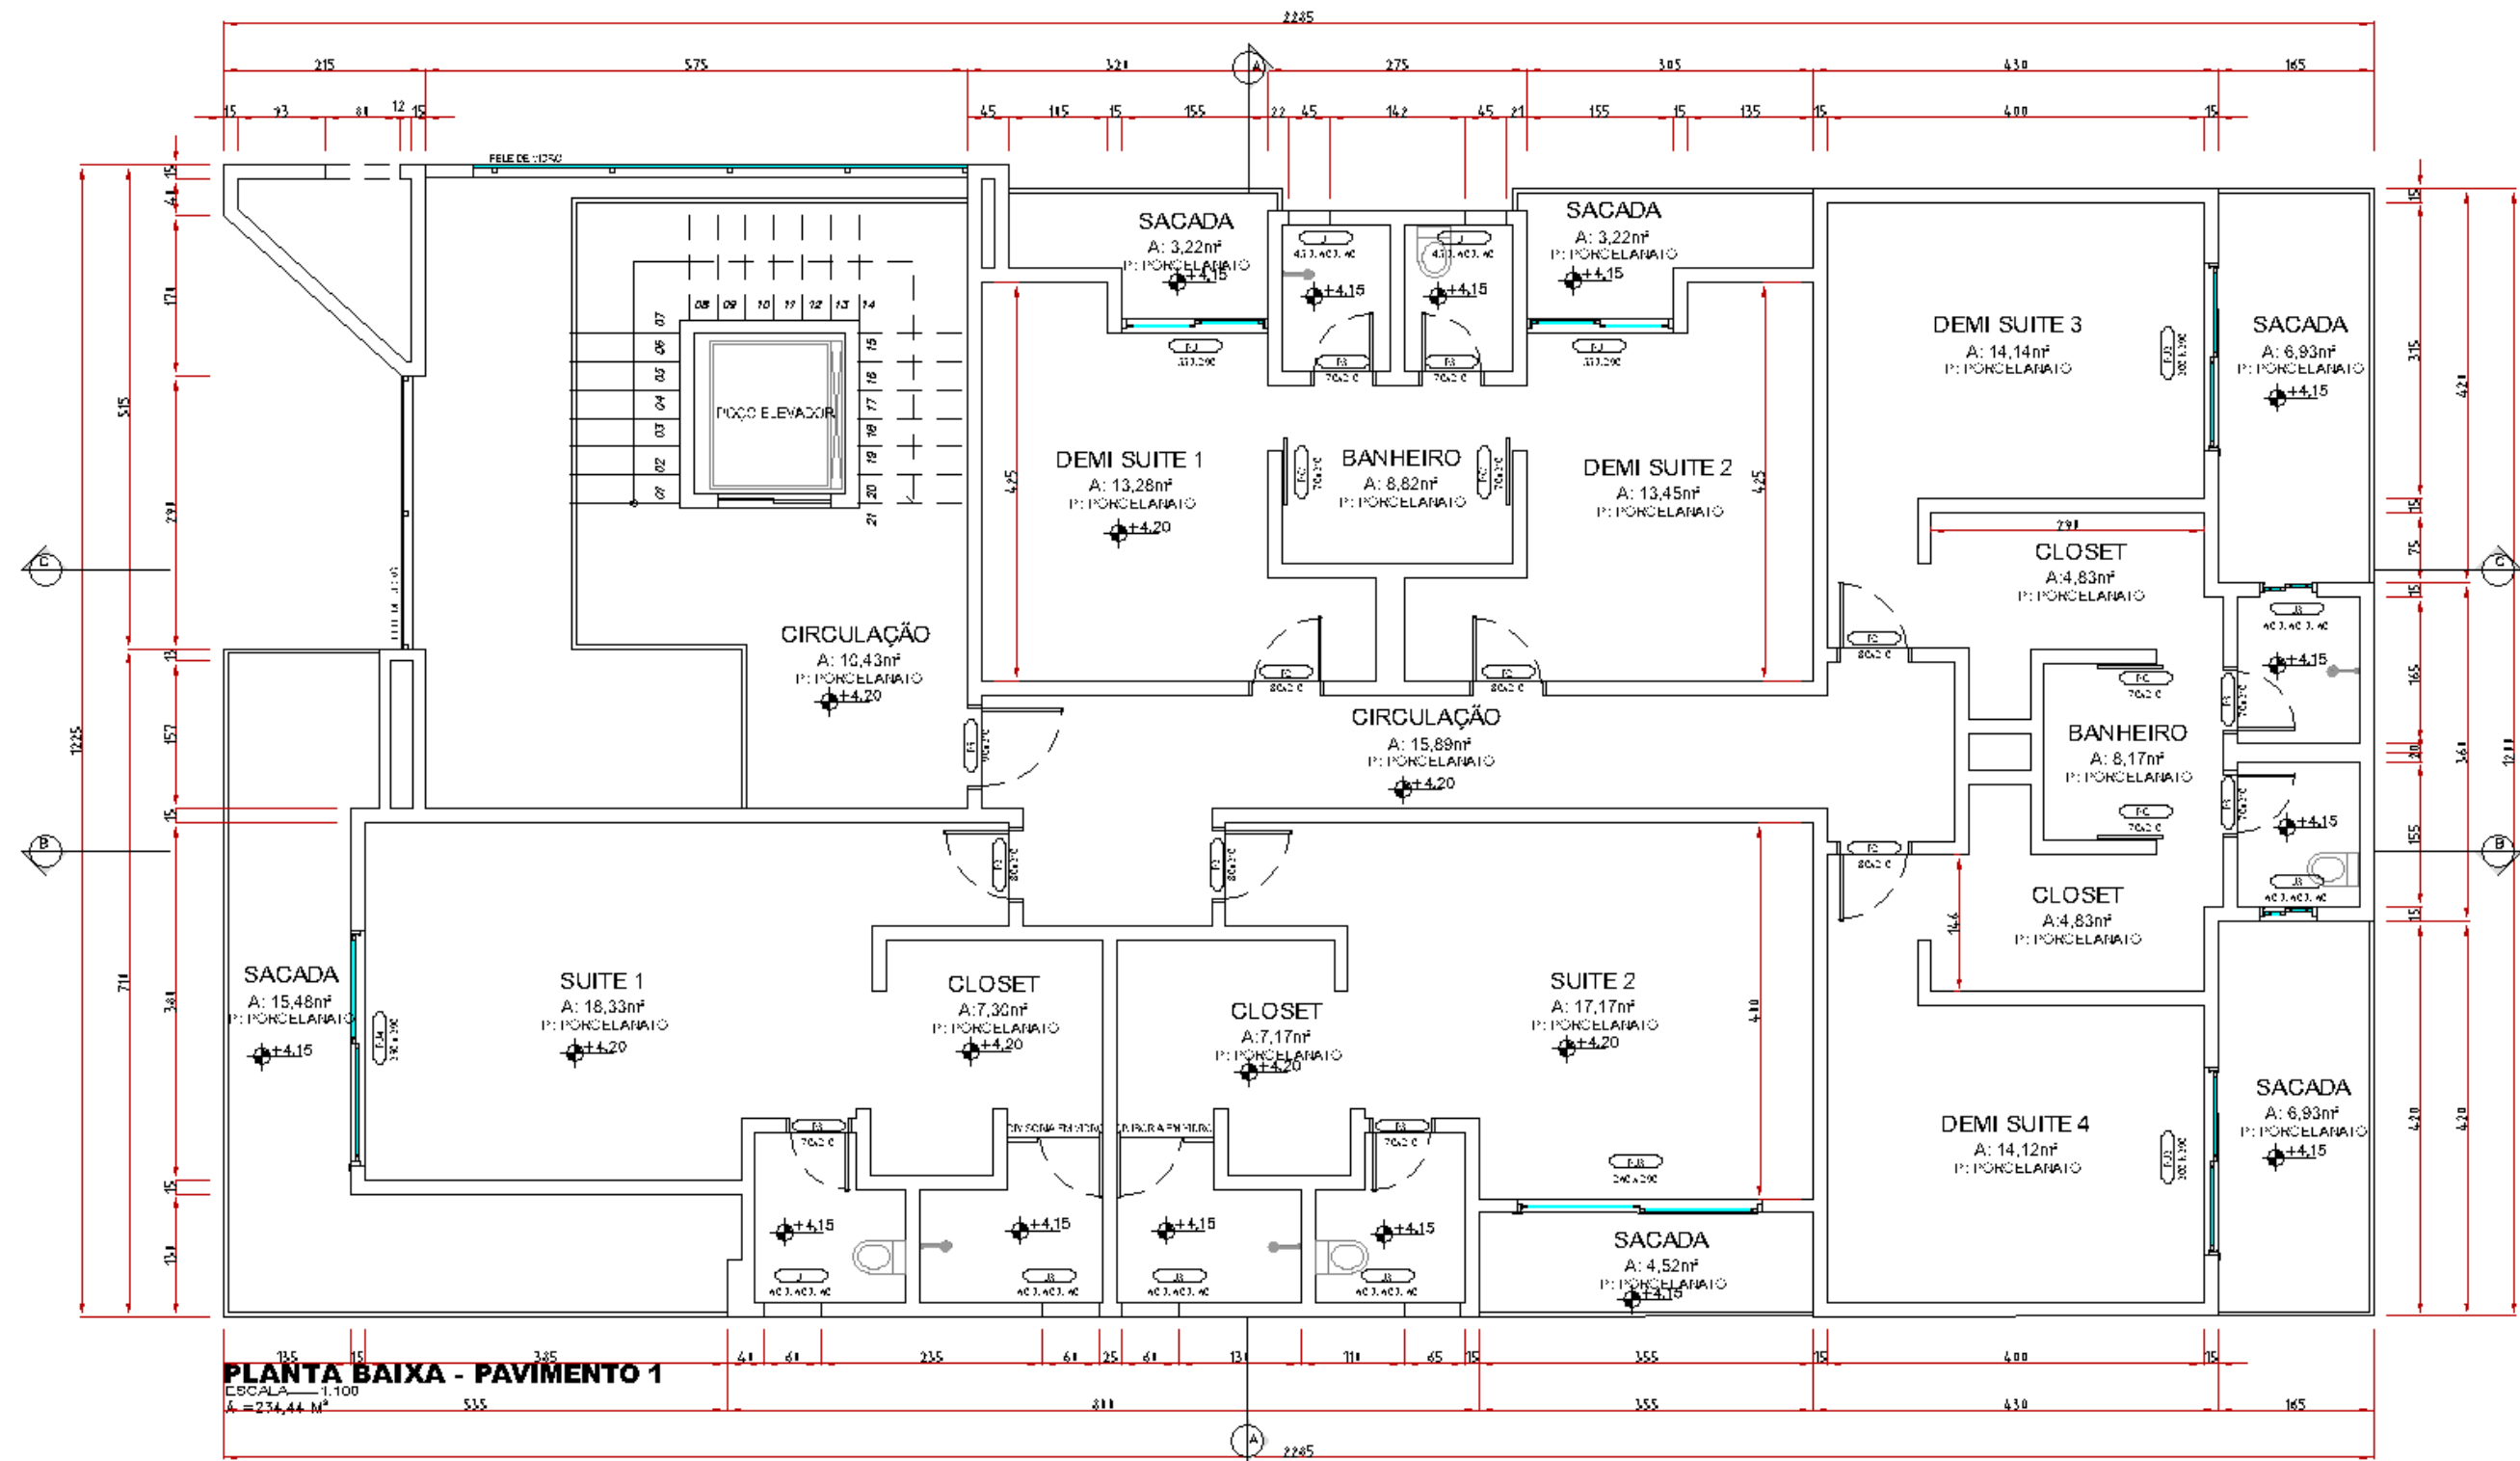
Planta Baixa 1º Pavimento. Fonte: Autor
